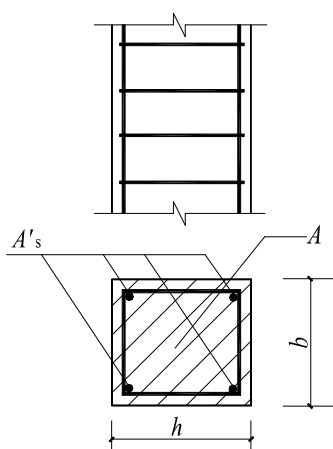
配置箍筋的钢筋混凝土轴心受压构件截面
